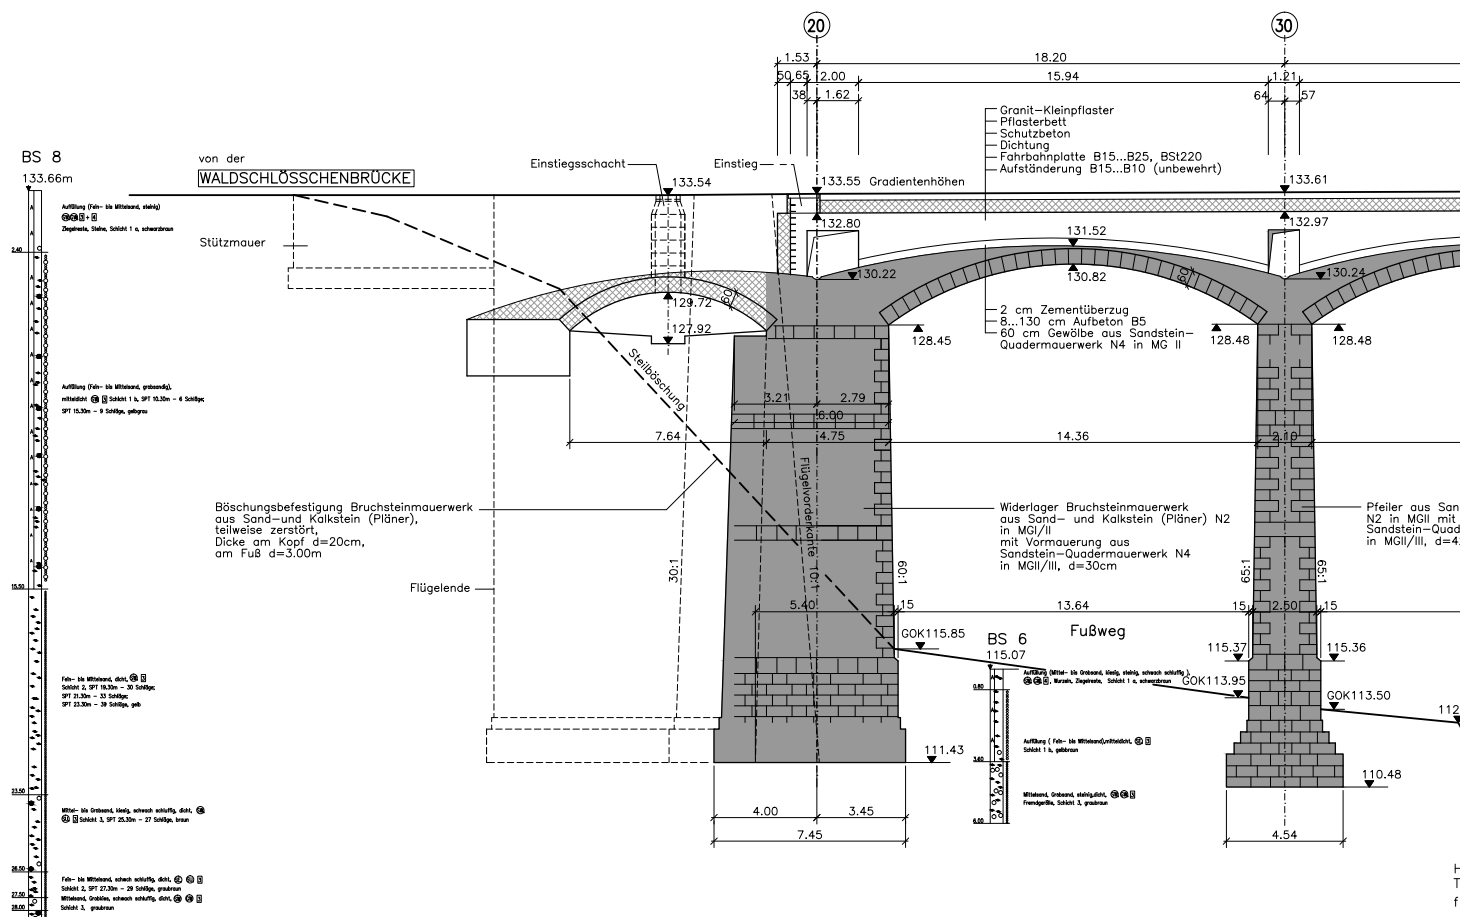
Längsschnitt des Bestands und nach dem Umbau
